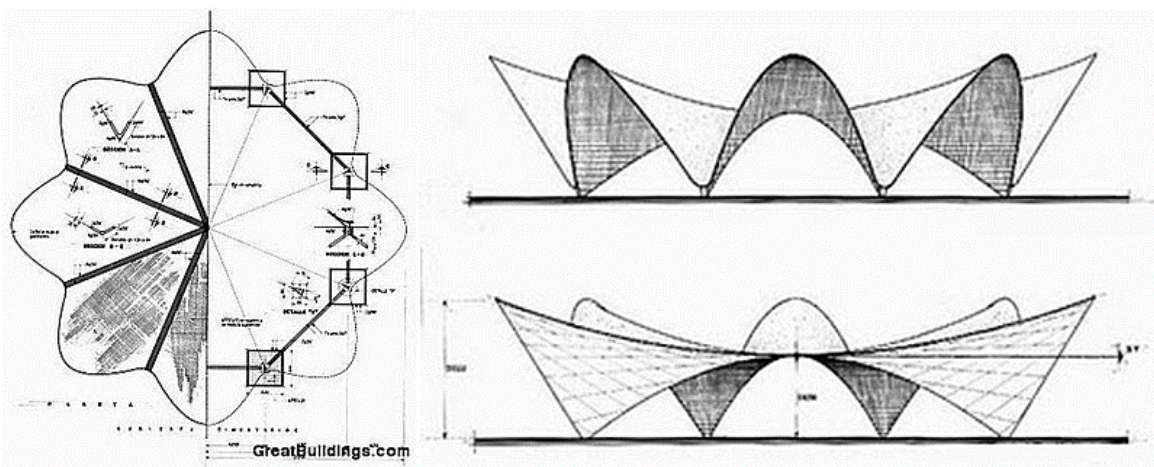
Félix Candela: Restaurante “Los Manantiales” en Xochimilco, planta, alzado y sección.
